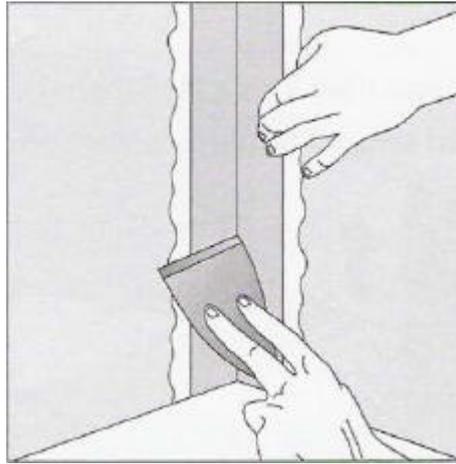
Colocação de fita metálica em junta de ângulo interno. Fonte: Abragesso, 2004.
